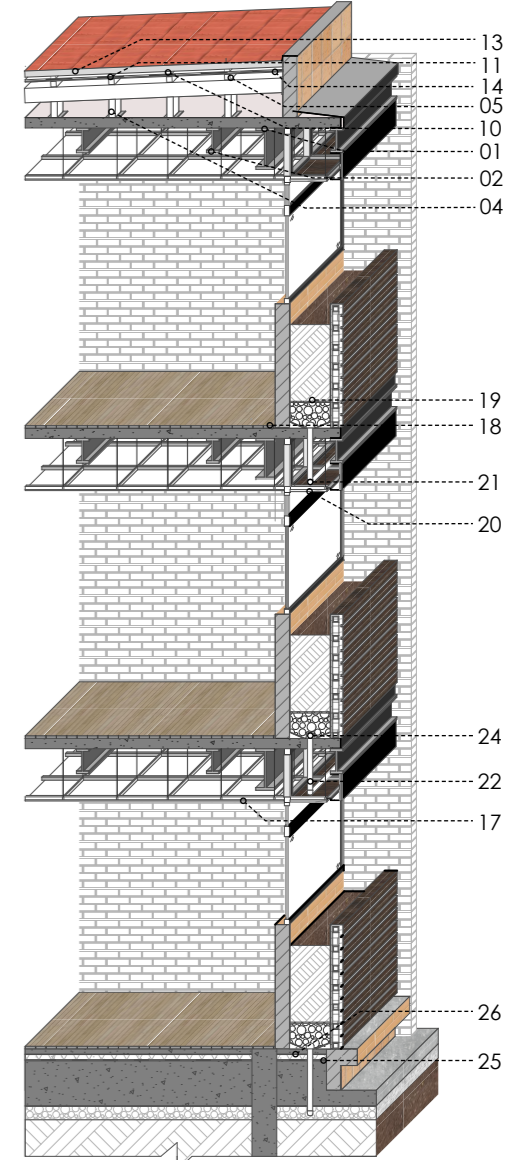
Axonometría de sección Tipo B Elaboración propia (2026). TB
